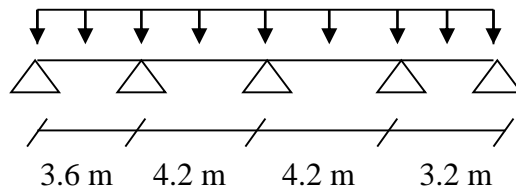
schéma statique de la poutre du 2^{ème} cas.
